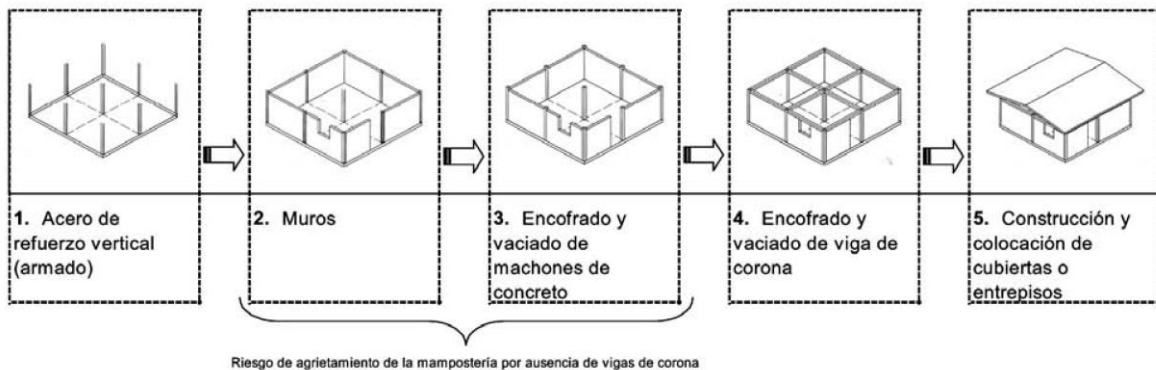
Proceso constructivo tradicional de mampostería confinada
